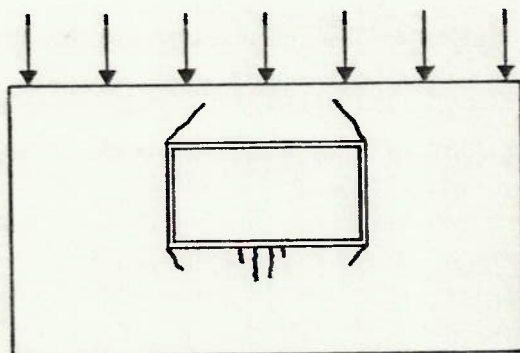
Fissuração teórica no entorno de abertura, em parede solicitada por sobrecarga vertical
